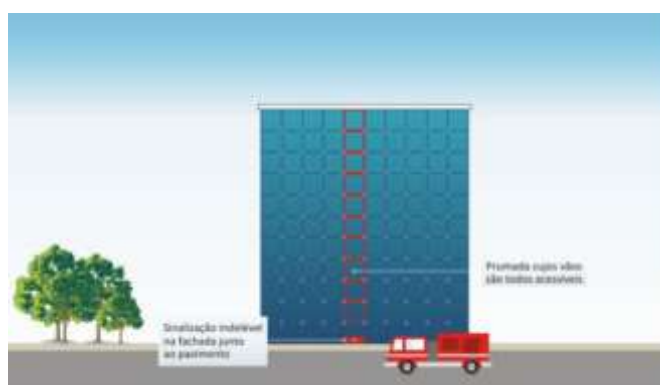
Sinalização dos pontos de penetração em fachadas.
